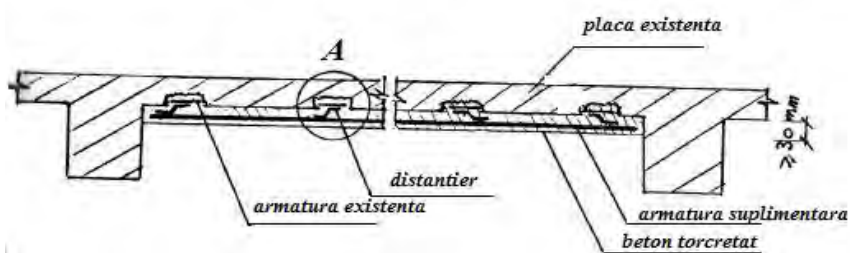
Consolidarea plăcilor din beton armat prin suplimentarea armăturilor din câmp [76]
